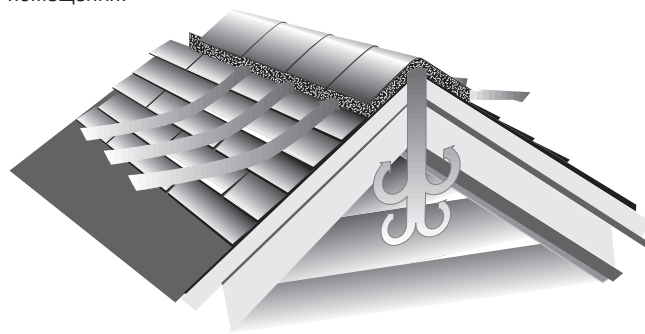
Вентиляционный конек с внутренней перегородкой или вообще без перегородки не «вытягивает» воздух из чердачного помещения через обе стороны вентиляционной секции.
